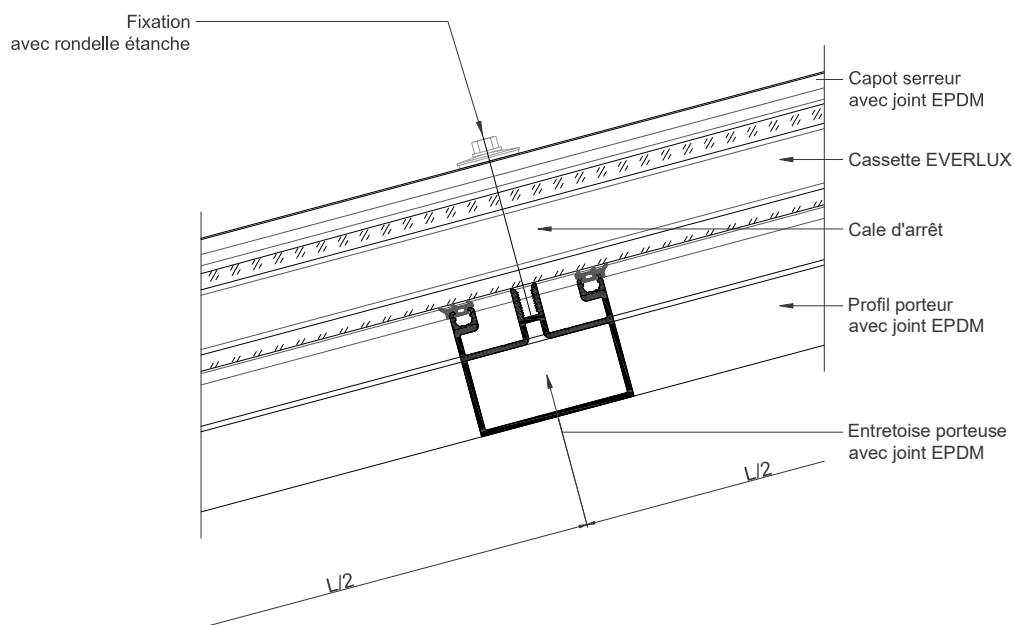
Coupe verticale appui intermédiaire sur cassette avec $L > 3050$ mm
